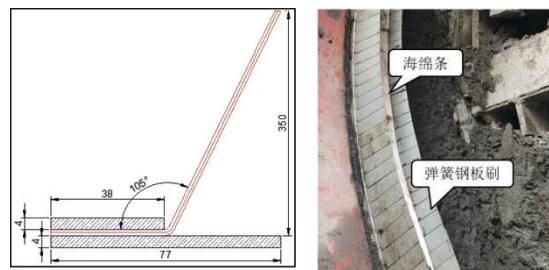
洞门钢圈内焊接弹簧钢板刷尺寸及安装图
